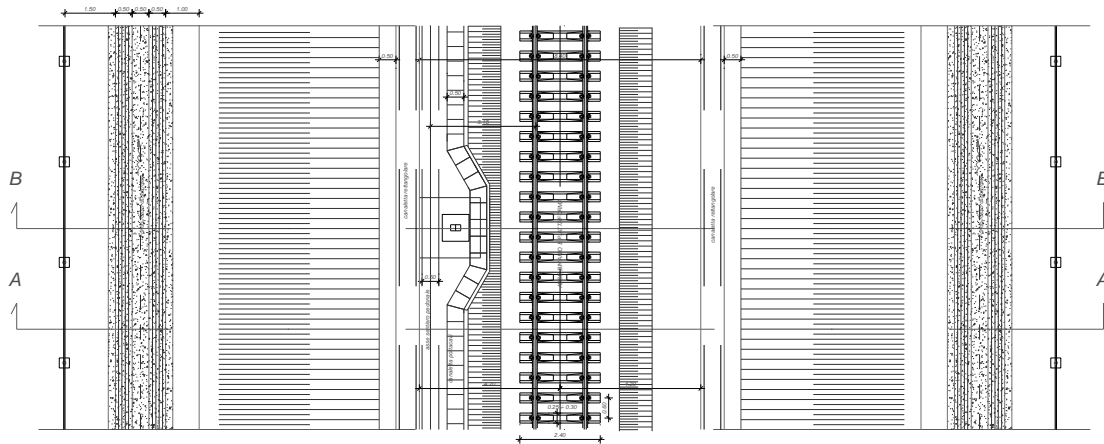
Stralcio planimetrico con sezione tipo ferroviaria in trincea a singolo binario in rettilo
